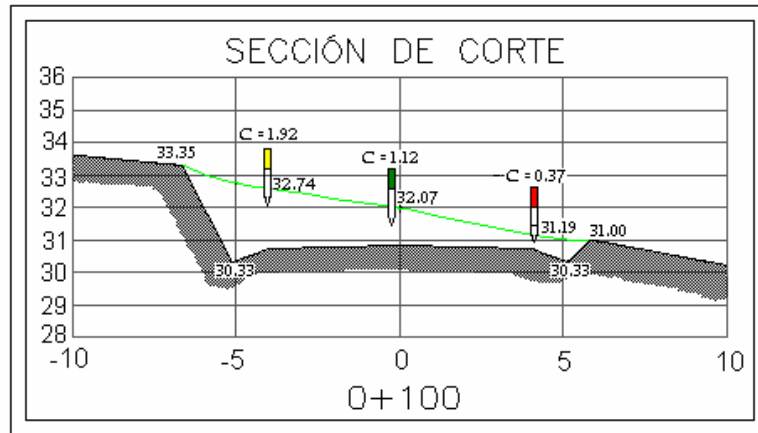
Colocación de estacado para el ancho de corte o relleno.
